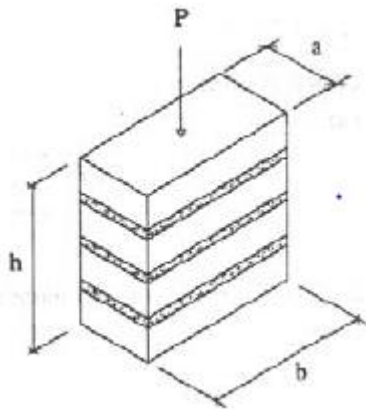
PILA DE ADOBE, FUENTE RNE E 080,2017
